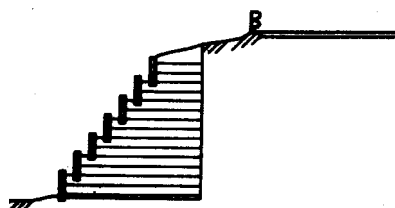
Сооружение из армированного грунта с габийной облицовкой
